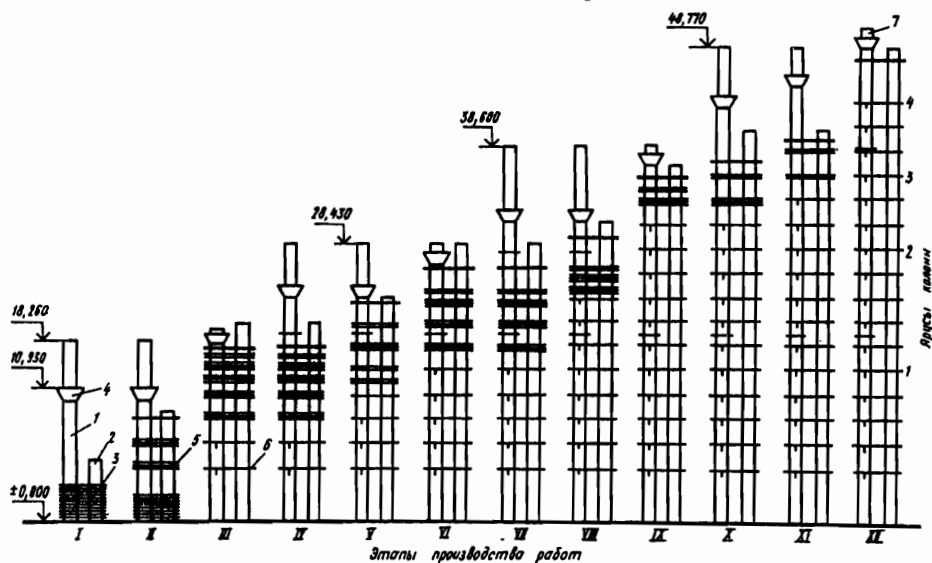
Технологическая схема подъема перекрытий с поярусным наращиванием колонн: 1 - колонна; 2 - стена ядра жесткости; 3 - пакет плит перекрытия; 4 - подъемник; 5 - плиты на промежуточных отметках; 6 - плиты перекрытий на проектных отметках; 7 - временные инвентарные колонны, установленные на вершинах верхнего яруса колонн для монтажа подъемников
